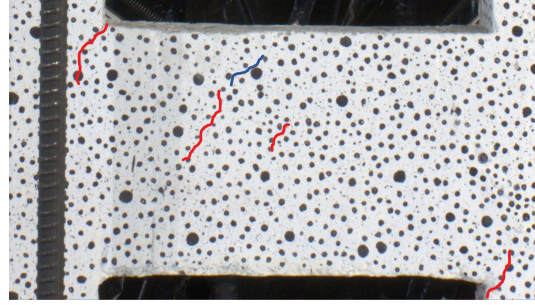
Grietas Vigas a -0.3% Drift
